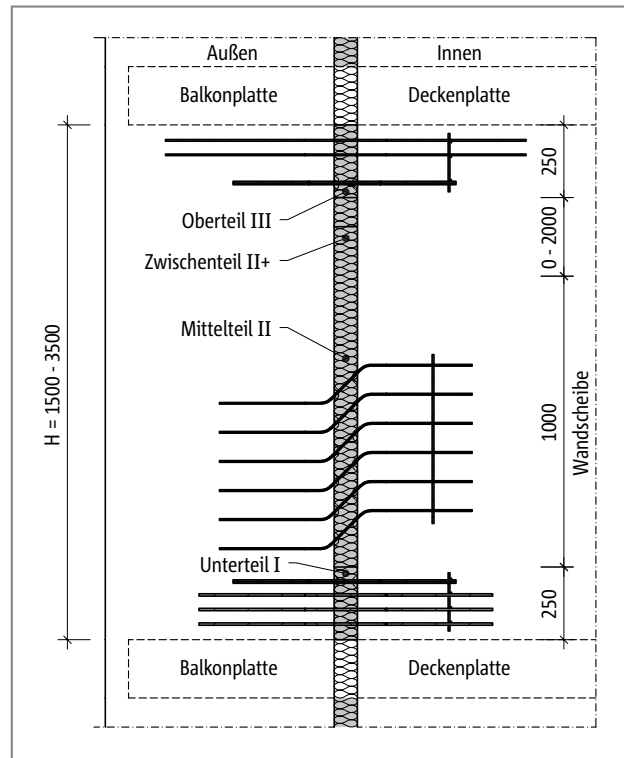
Schöck Isokorb® T Typ W: Balkonkonstruktion mit wärmegeämmten tragenden Wandscheiben
